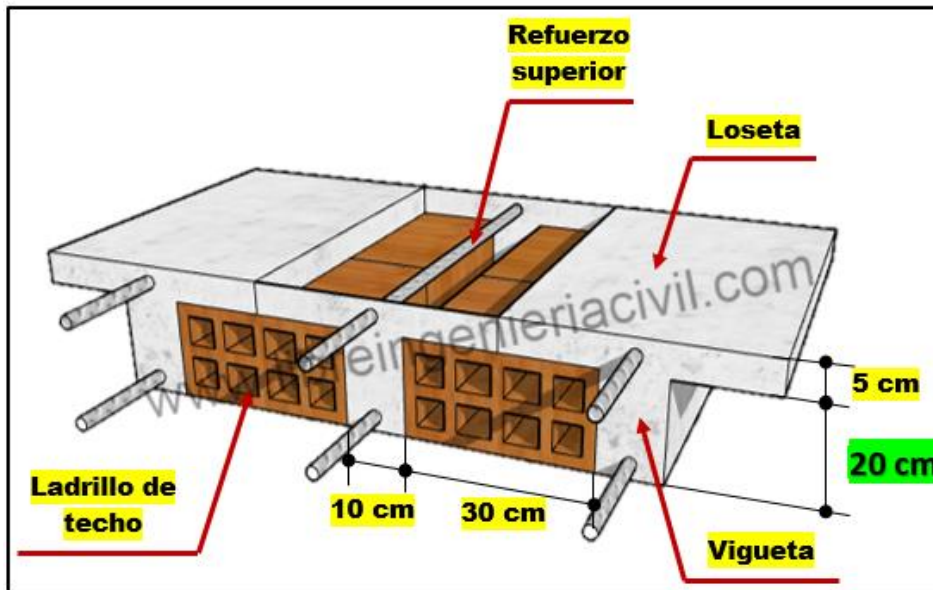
Losa aligerada (Libre Ingeniería Civil, 2021)
